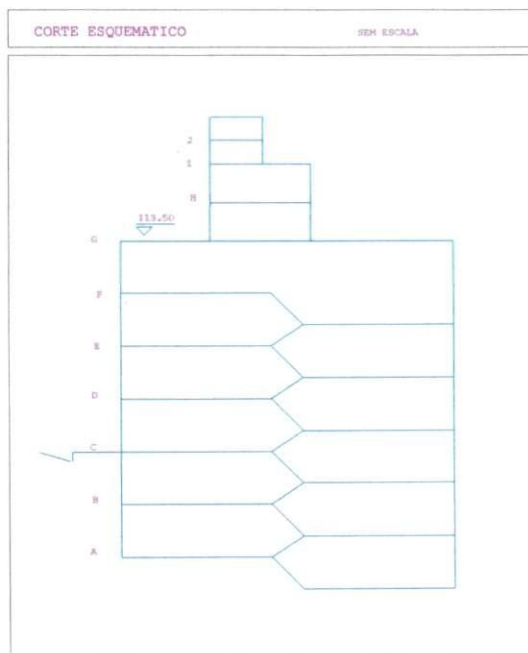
Corte esquemático de um edifício de concreto armado
